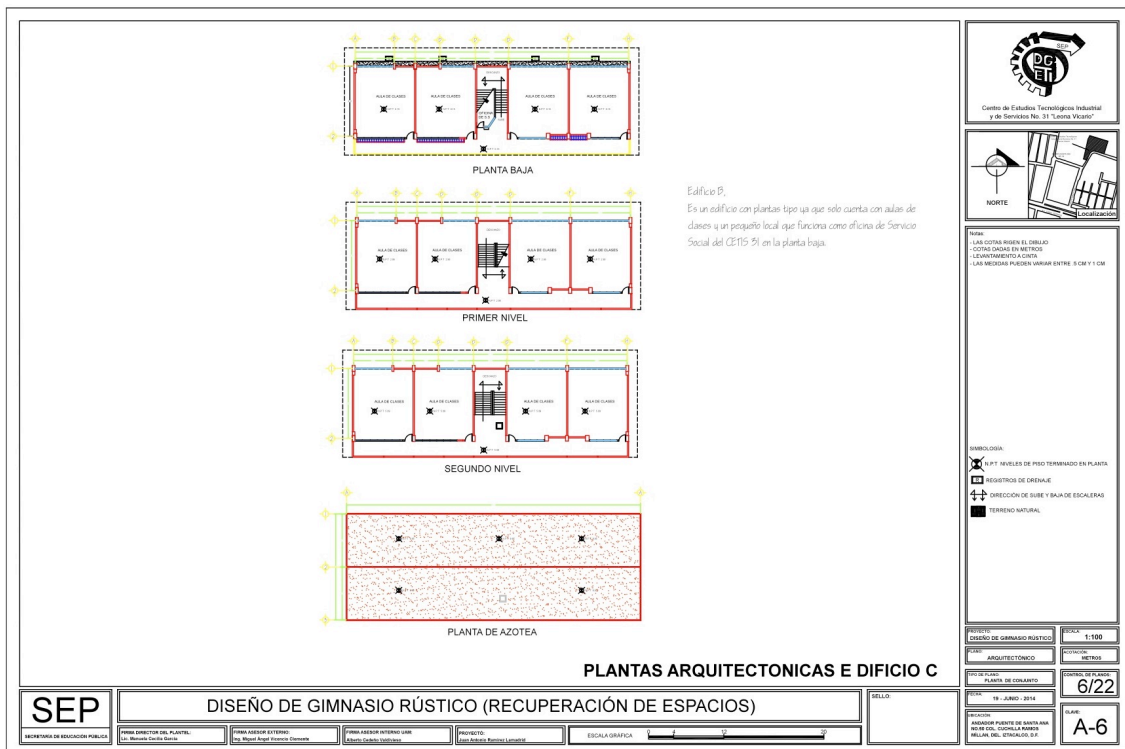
Plantas arquitectonicas del edificio B, levantamiento por Juan Ramírez.
